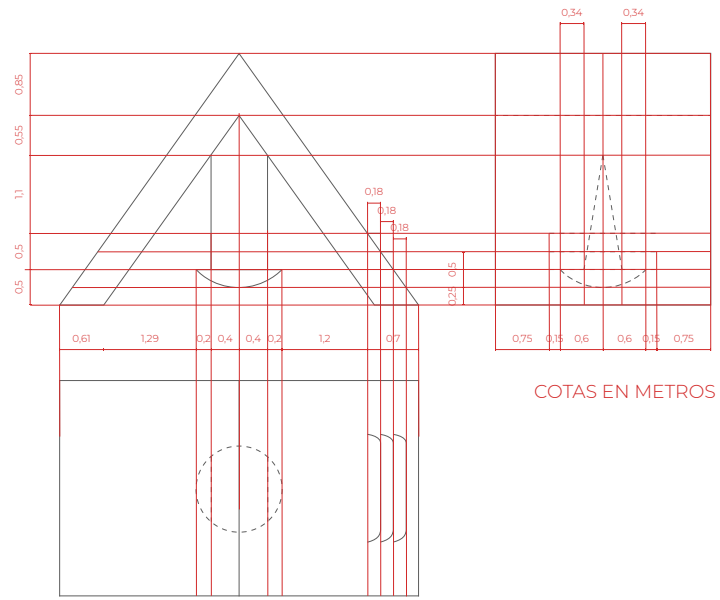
Dibujo Constructivo II. Estructura roja, elaboración propia..
